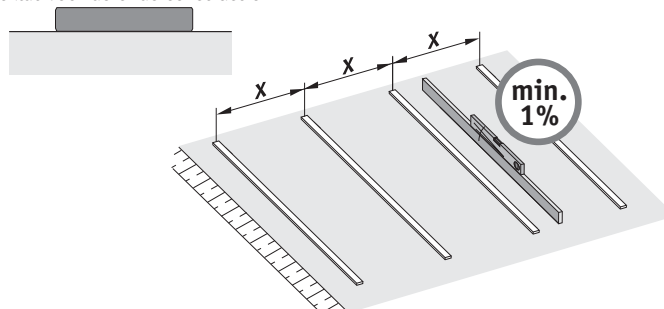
Leggen met latten voor de onderconstructie op betonvloeren
